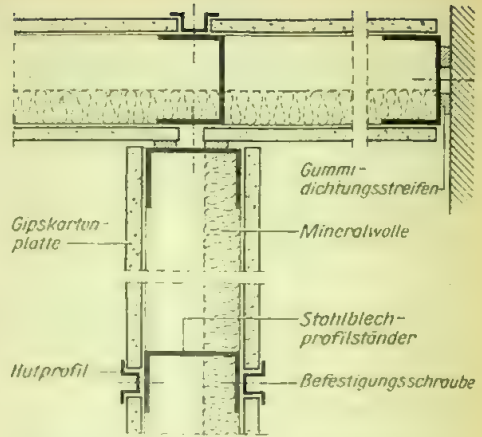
Grundriß einer Trennwand in Ständerbauweise bis 4000 mm Höhe (Stahlblechprofilständer)
